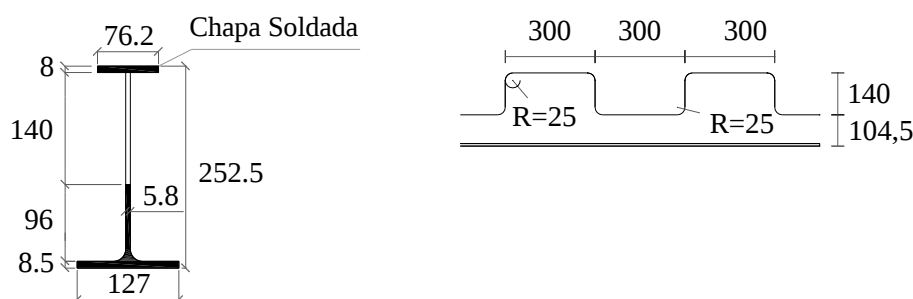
Detalhamento das dimensões e posicionamento das armaduras na viga mista (dimensões em mm)
